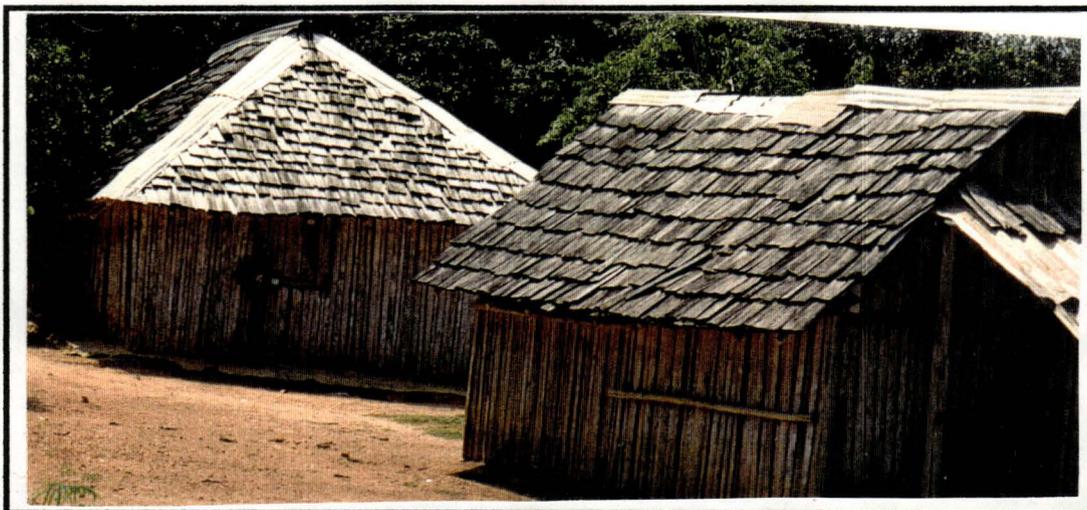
Habitação com utilização de madeira roliça, tábuas e telha de madeira (cavaco).
